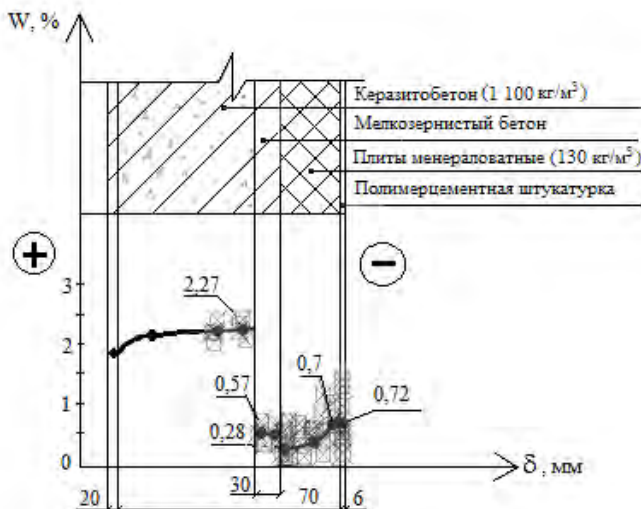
Распределение массовой влажности по сечению наружной стены из керамзитобетонных панелей с наружной дополнительной теплоизоляцией
